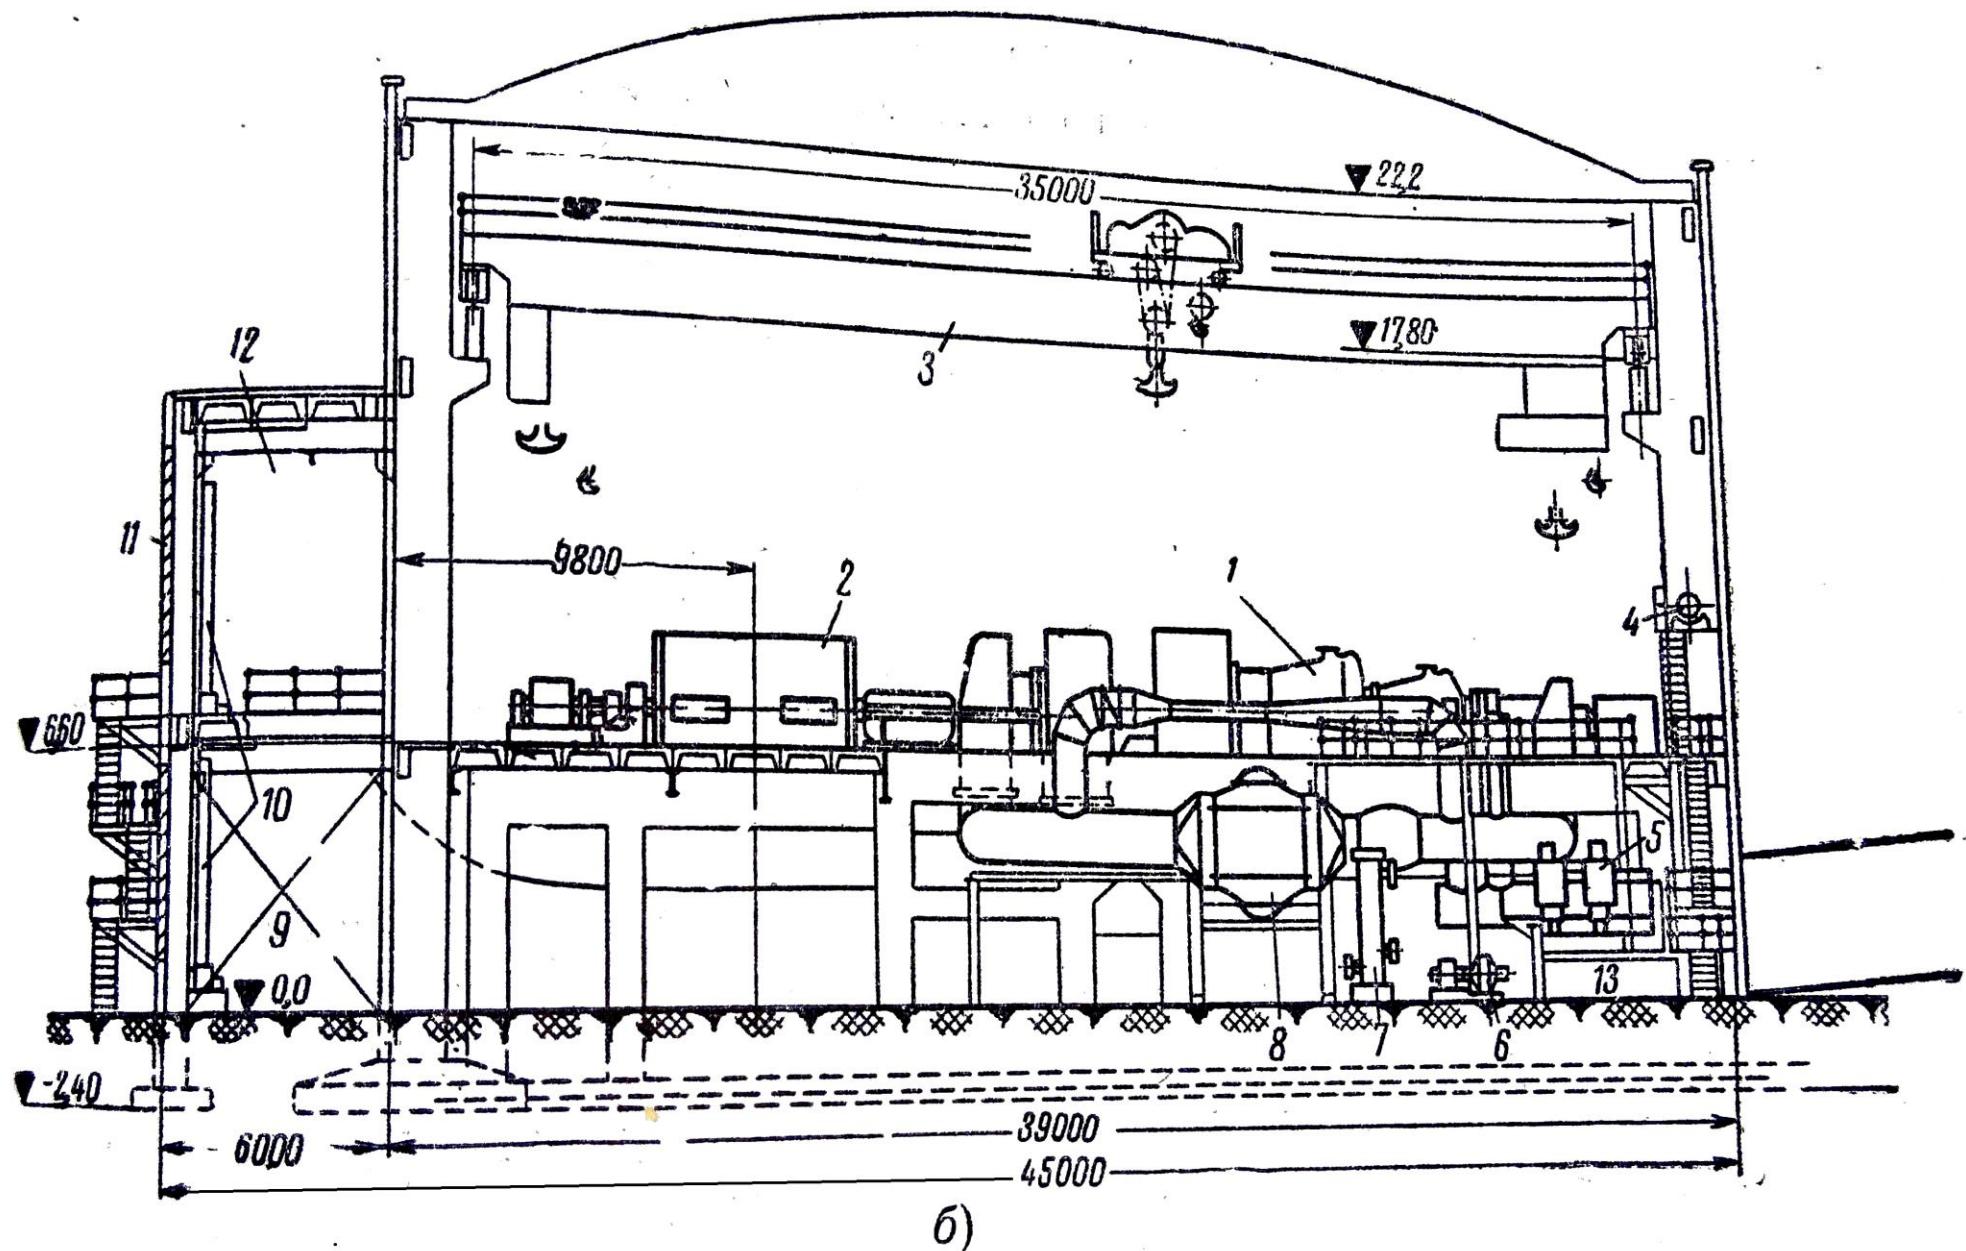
(б) Главный корпус газотурбинной ТЭС (поперечный разрез)
